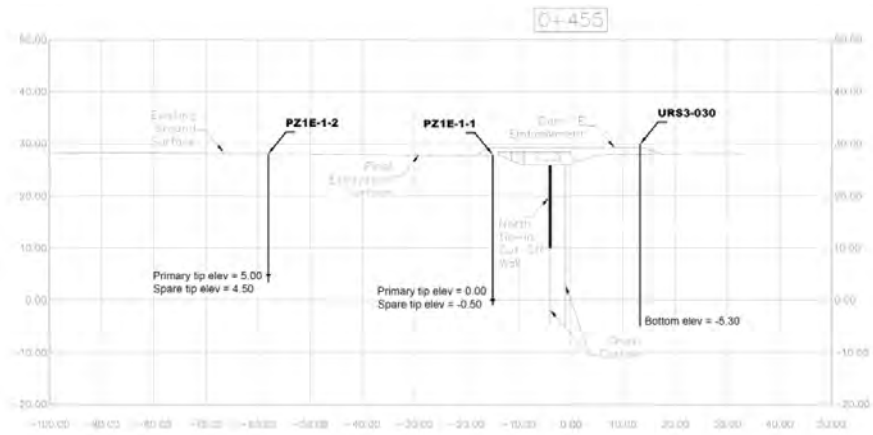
Sección B, transversal al muro, estación 0+455.
